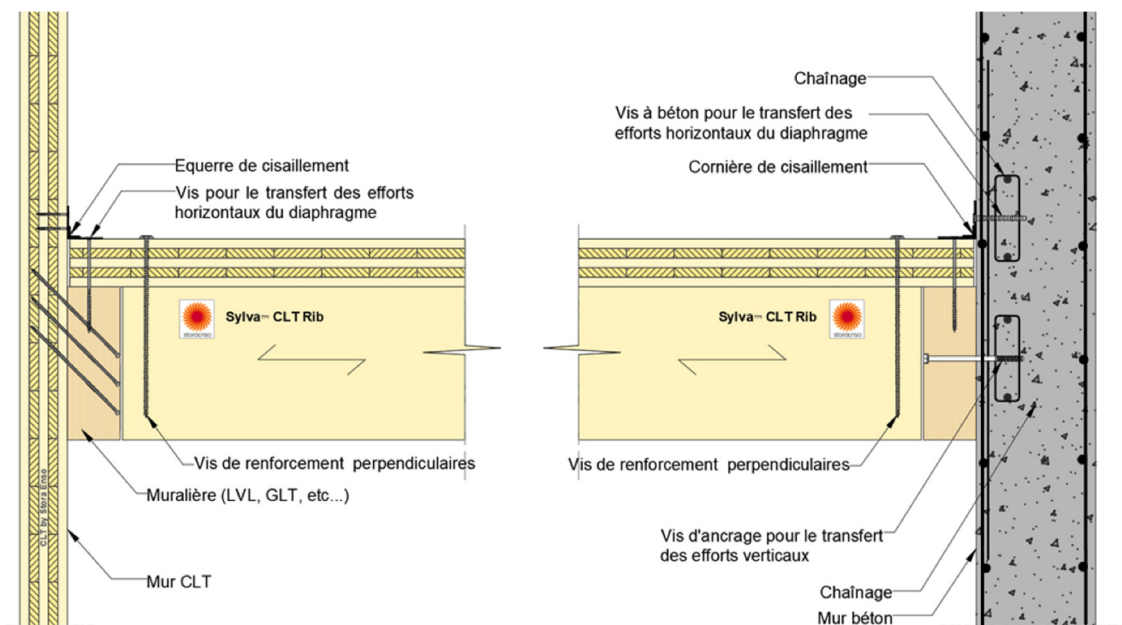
Exemple d'appui simple sur poutre muralière avec liaison sur mur CLT et mur béton – Caisson ouvert
